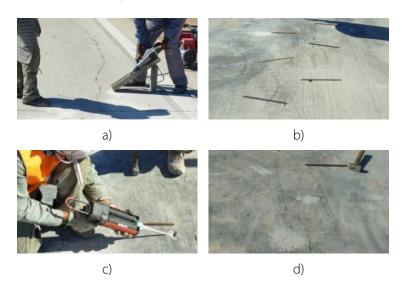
Cosido cruzado de grietas y juntas longitudinales Fuente: Calo. (2016)
